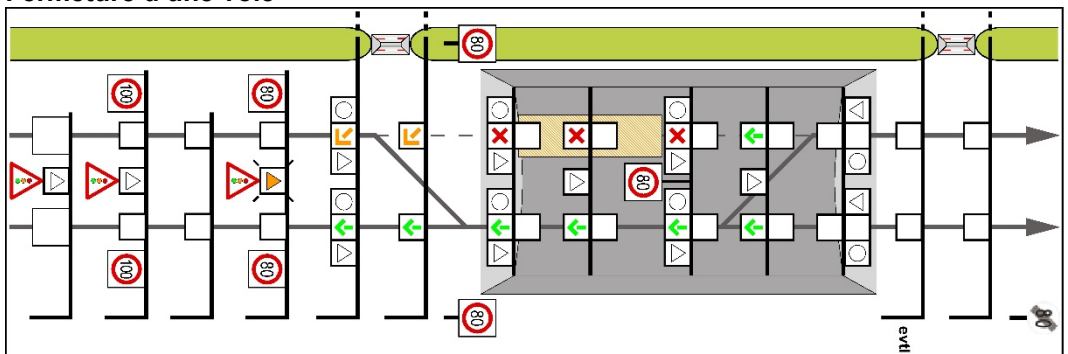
Plan de feux – Fermeture de la voie de gauche.
